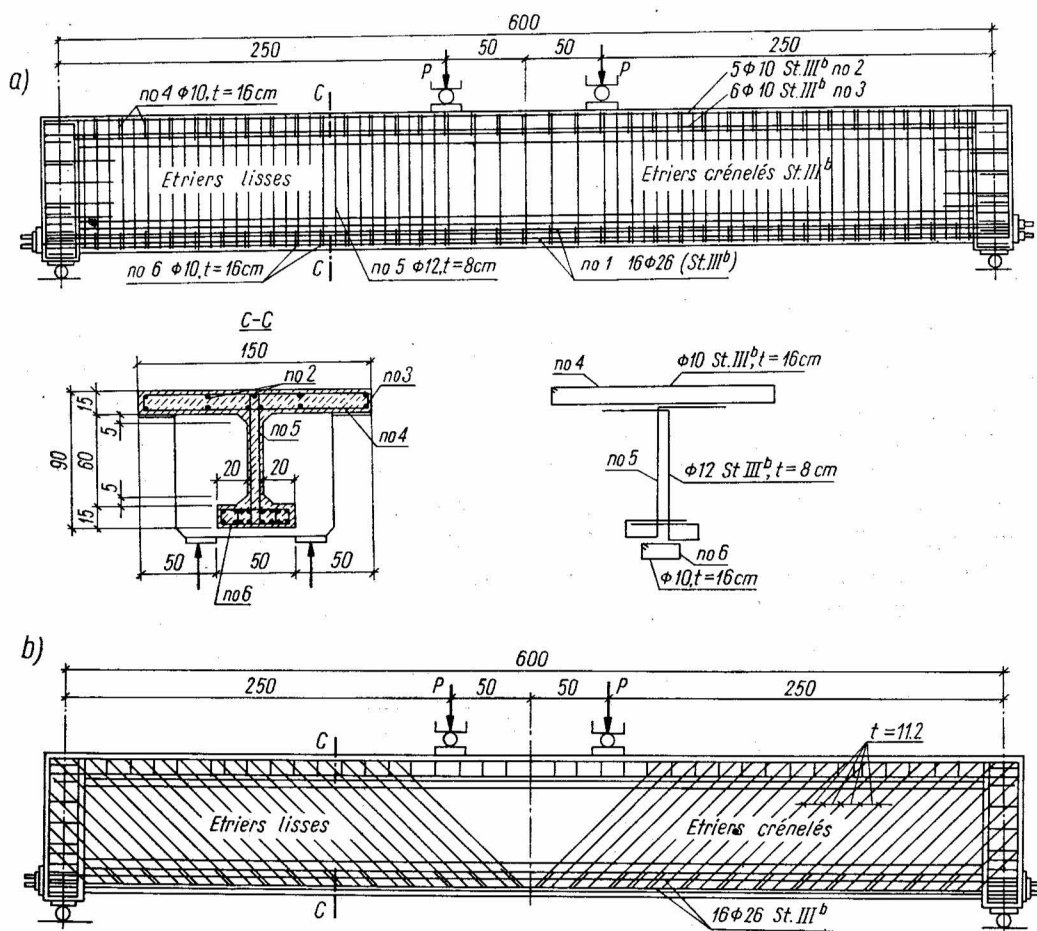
Armature des poutres en forme de T dans les essais de LEONHARDT et WALTHER [51] : a) poutre T1
